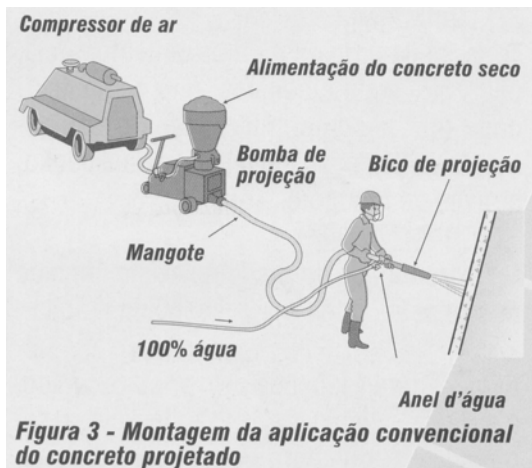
Aplicação de concreto projetado na face do muro (Manual Solotrat, 2006).
